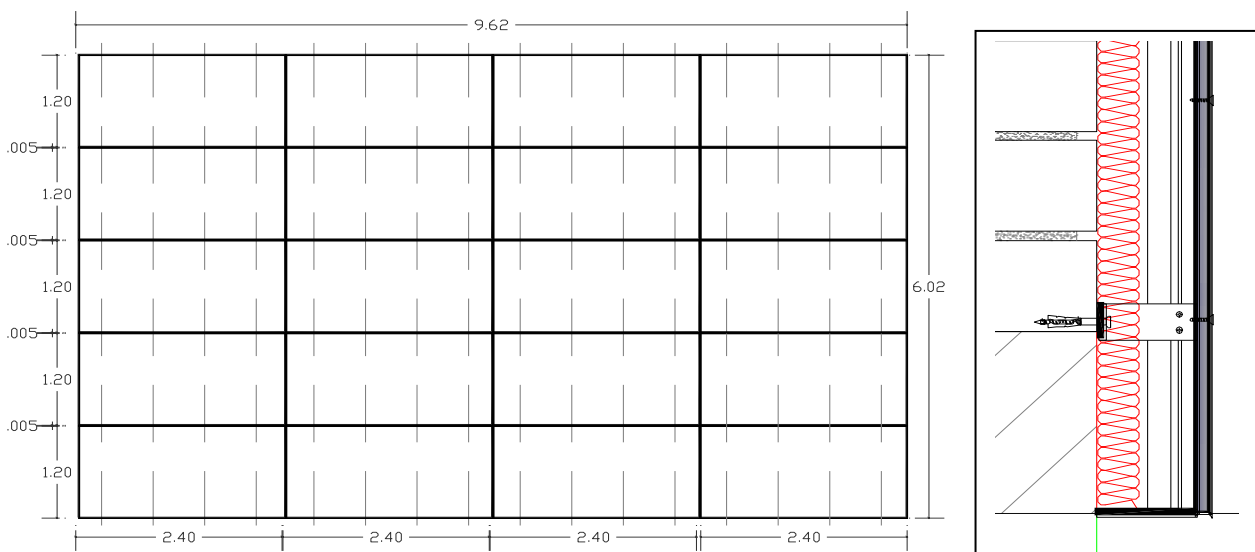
Disposición de las placas en alzado de fachada y detalle en sección vertical (D)
